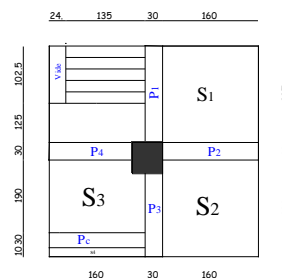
Surface revenant au poteau de la cage d'escalier
